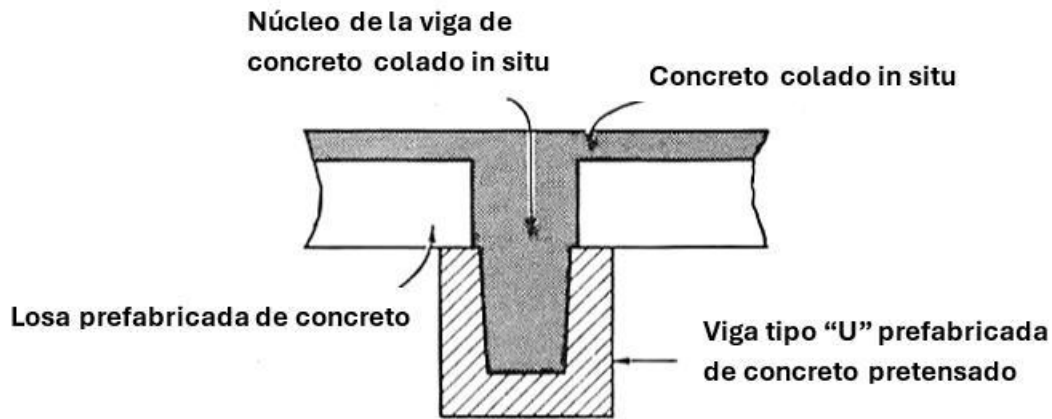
Sección transversal de la viga prefabricada tipo "U" del edificio terminado, no se muestra el acero de refuerzo, (adaptada de Park y col., 1986)
